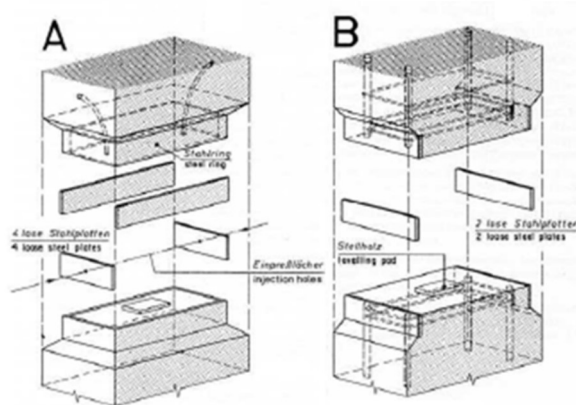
Ligação por soldagem de chapas (Stupré, 1981)
